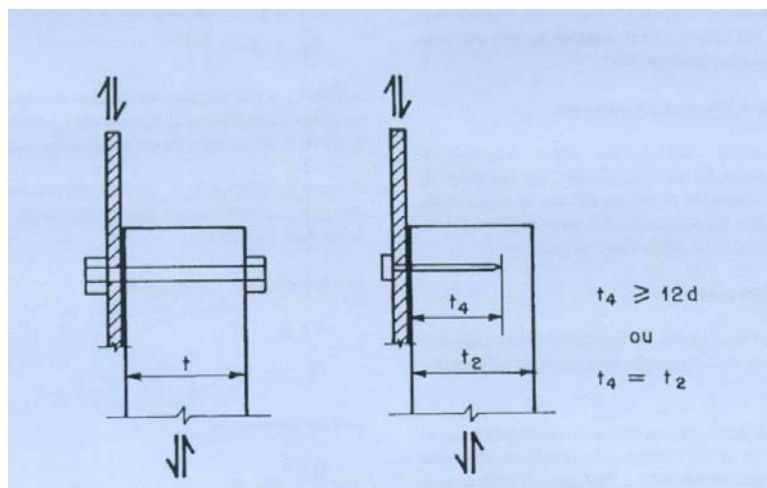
Ligação entre peça de madeira e peça metálica. Fonte: NBR 7190 (1997)
